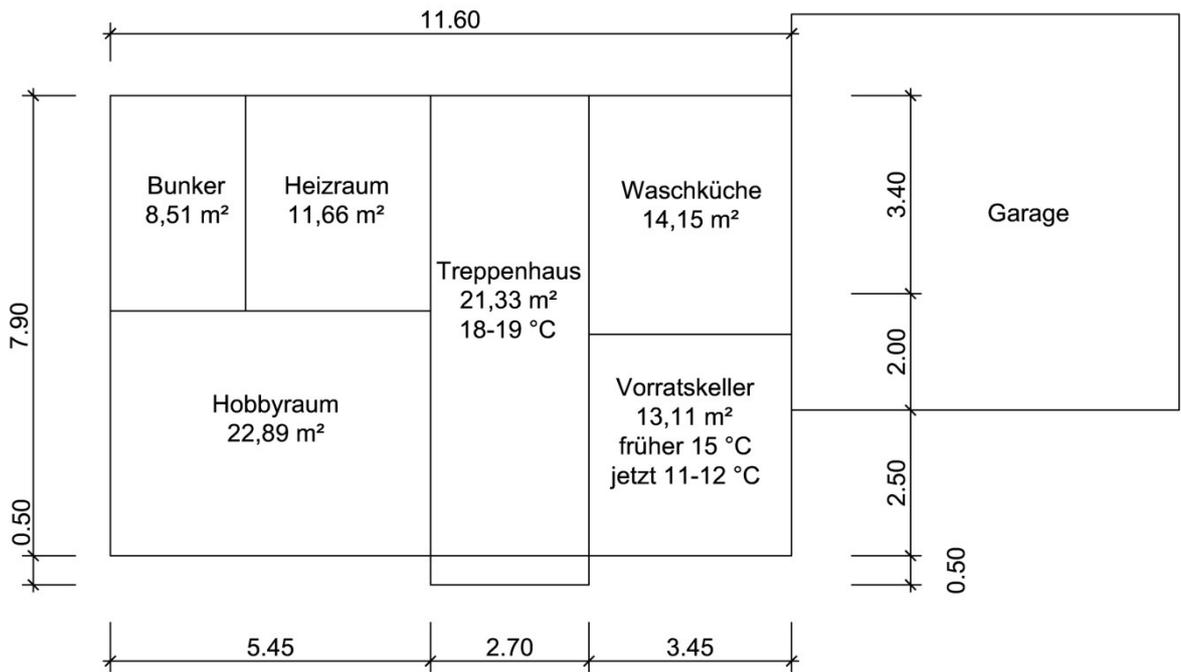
Grundriss: teilweise konditionierter Keller
